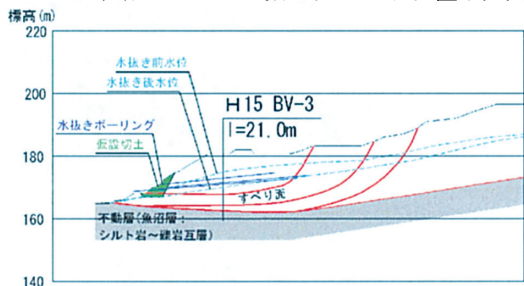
仮設切土及び水抜きボーリング断面図(C断面)
